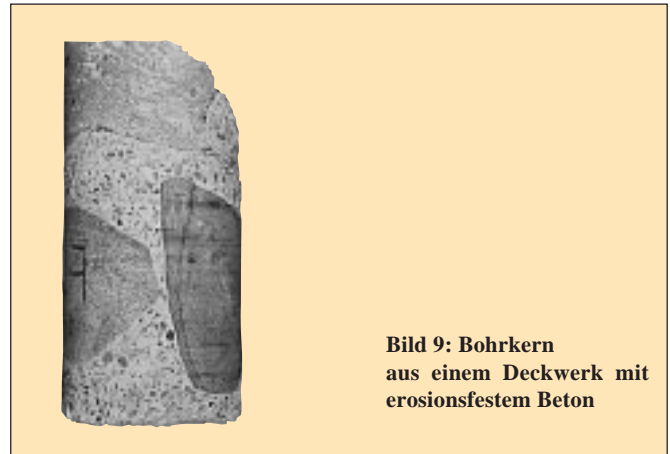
Bohrkern aus einem Deckwerk mit erosionsfestem Beton
